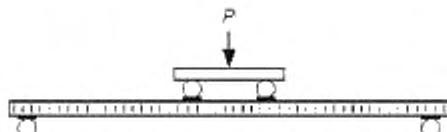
Испытываемый образец и приспособление для проведения испытания
